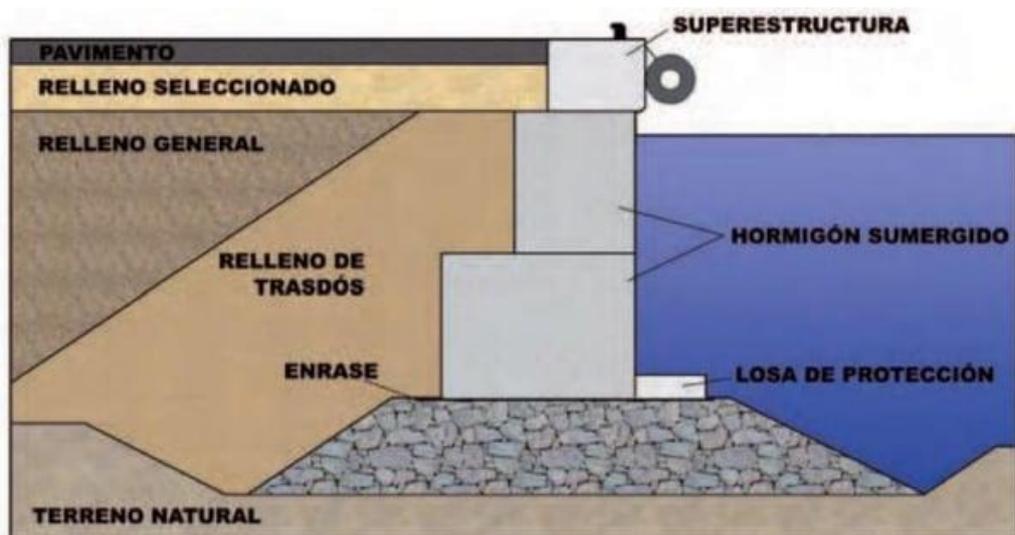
Muelles de hormigón sumergidos. (Structuralia, 2024)
